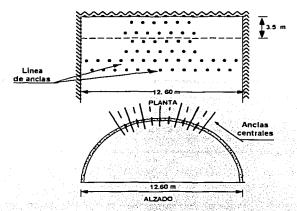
Anclaje central utilizando elementos de 1 * Ø x 4.2 m.
